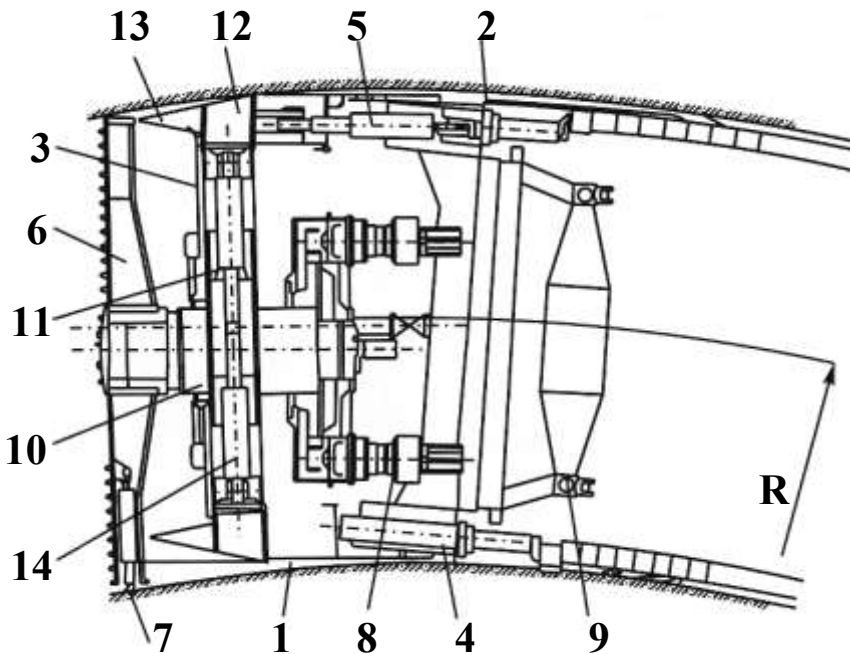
Конструктивная схема щитовой машины с шарнирным корпусом второго вида
